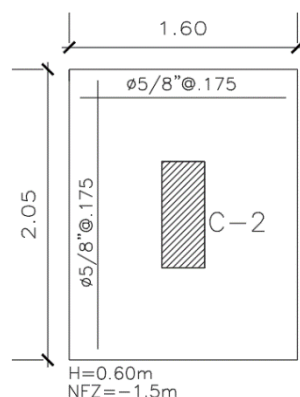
Detalle de armado de la zapata de la columna entre ejes A-3 de sistema dual
